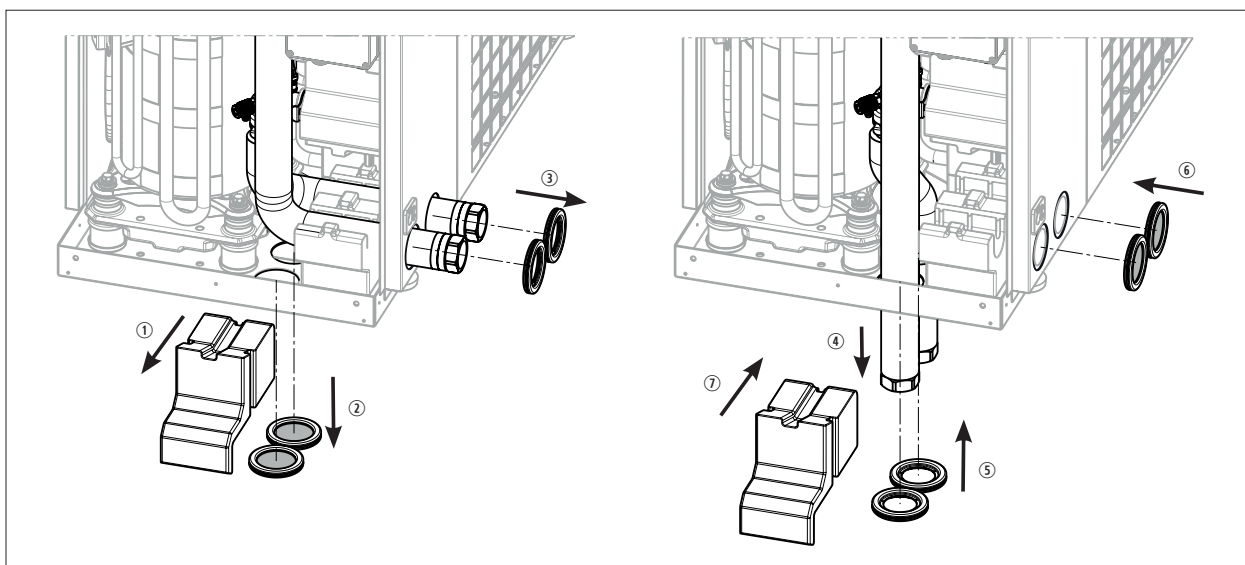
Odstraňte zajištění kompresoru pro přepravu
